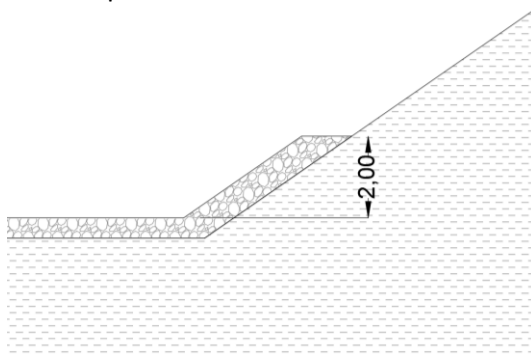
Pacchetto di sponda sopra Legoli 2
